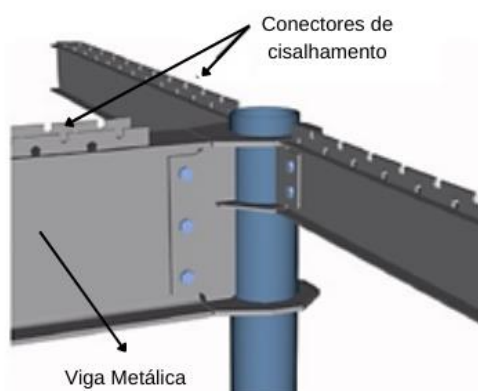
União viga/pilar e conectores de cisalhamento na viga metálica (adaptado de CAVALCANTE, 2010)
